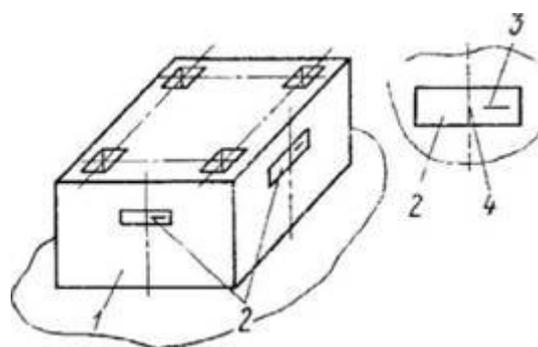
Схема планки для нанесения на фундаментах осей и высотных отметок:
